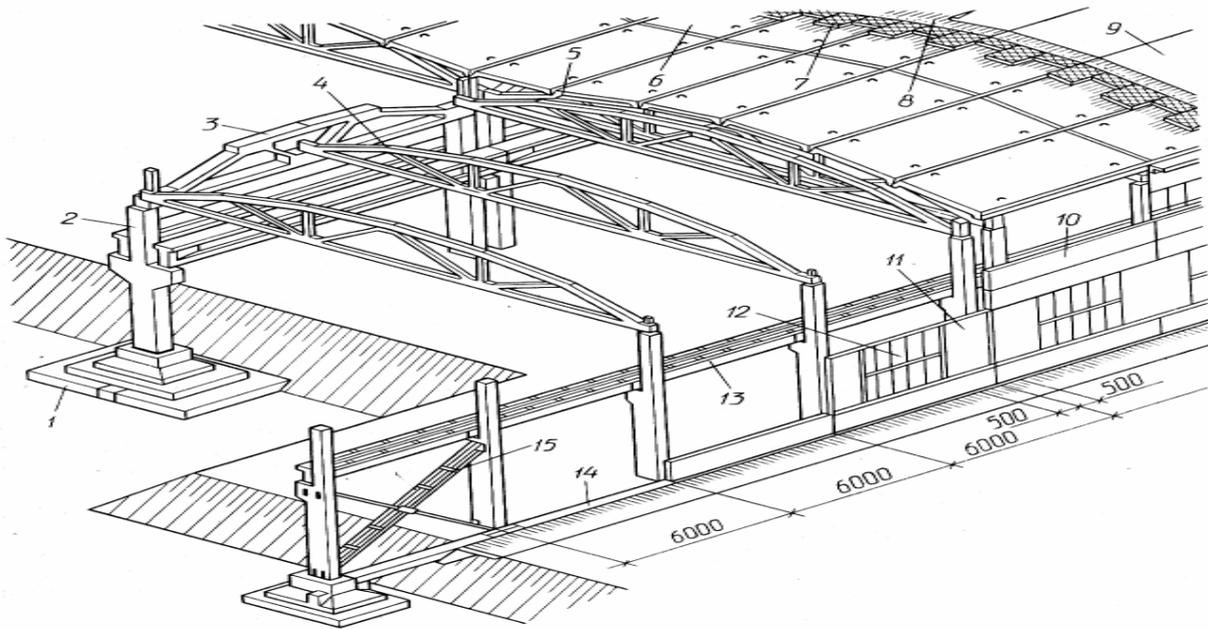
Залізобетонний каркас з кроквяними фермами:
